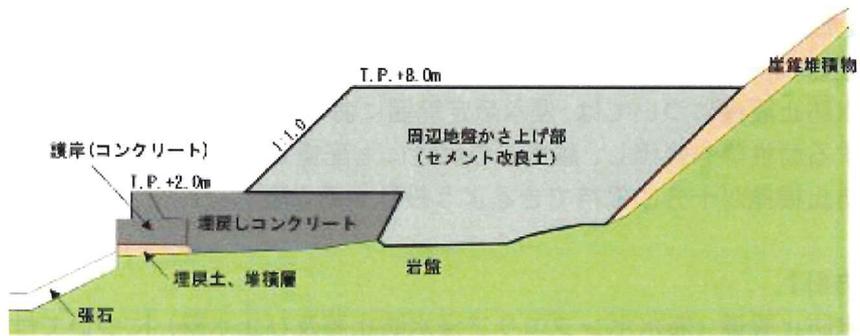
周辺地盤かさ上げ部断面図 (④-④断面)
